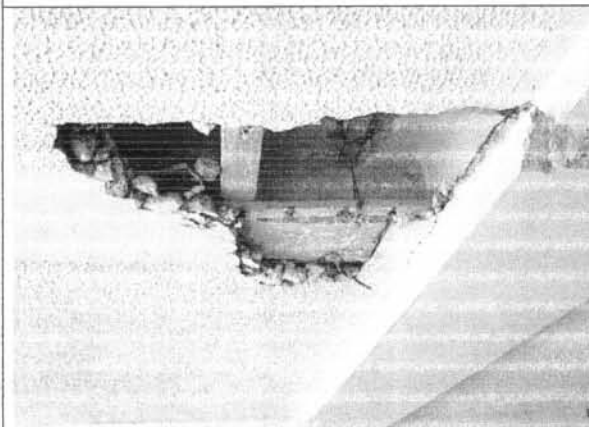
Detalle de caída de la torta inferior de la placa aligerada de piso 2.
